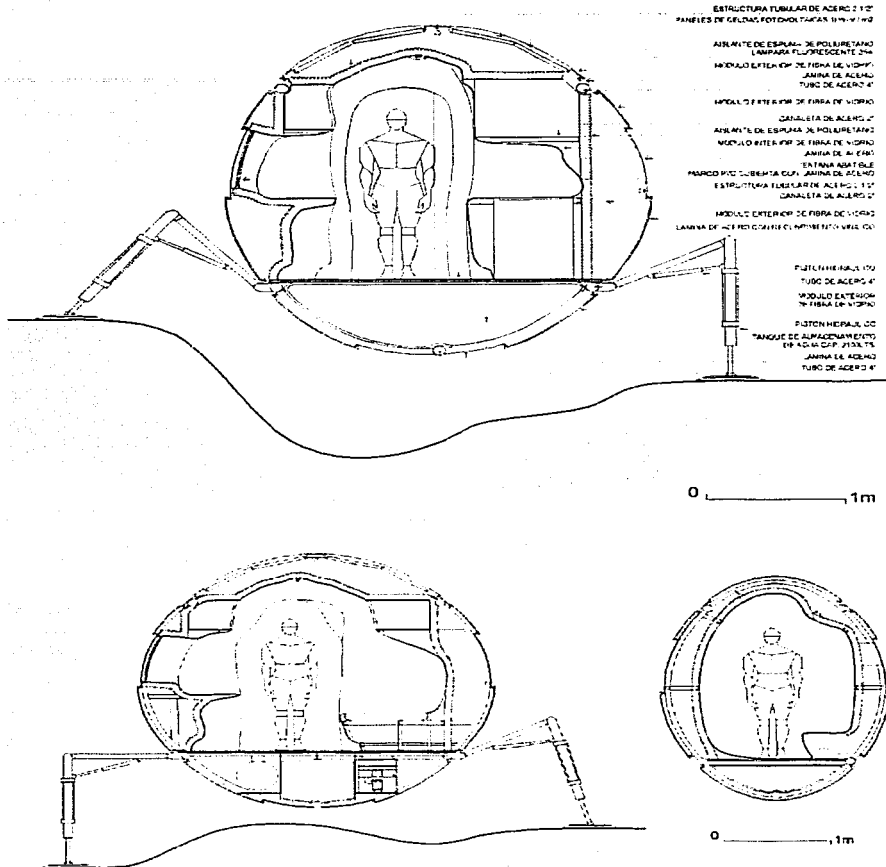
Corte en perspectiva del lado izquierdo (arriba);
